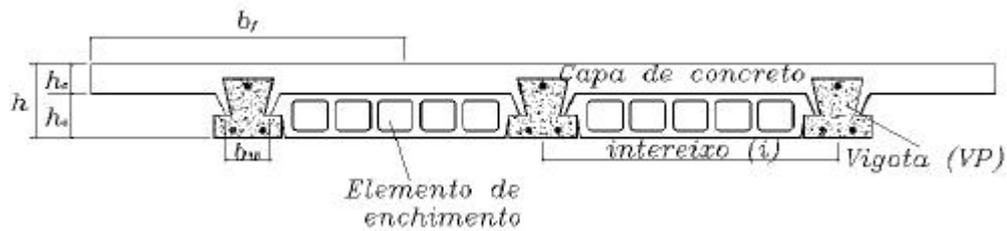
Seção transversal de laje pré-fabricada com vigotas protendidas.
